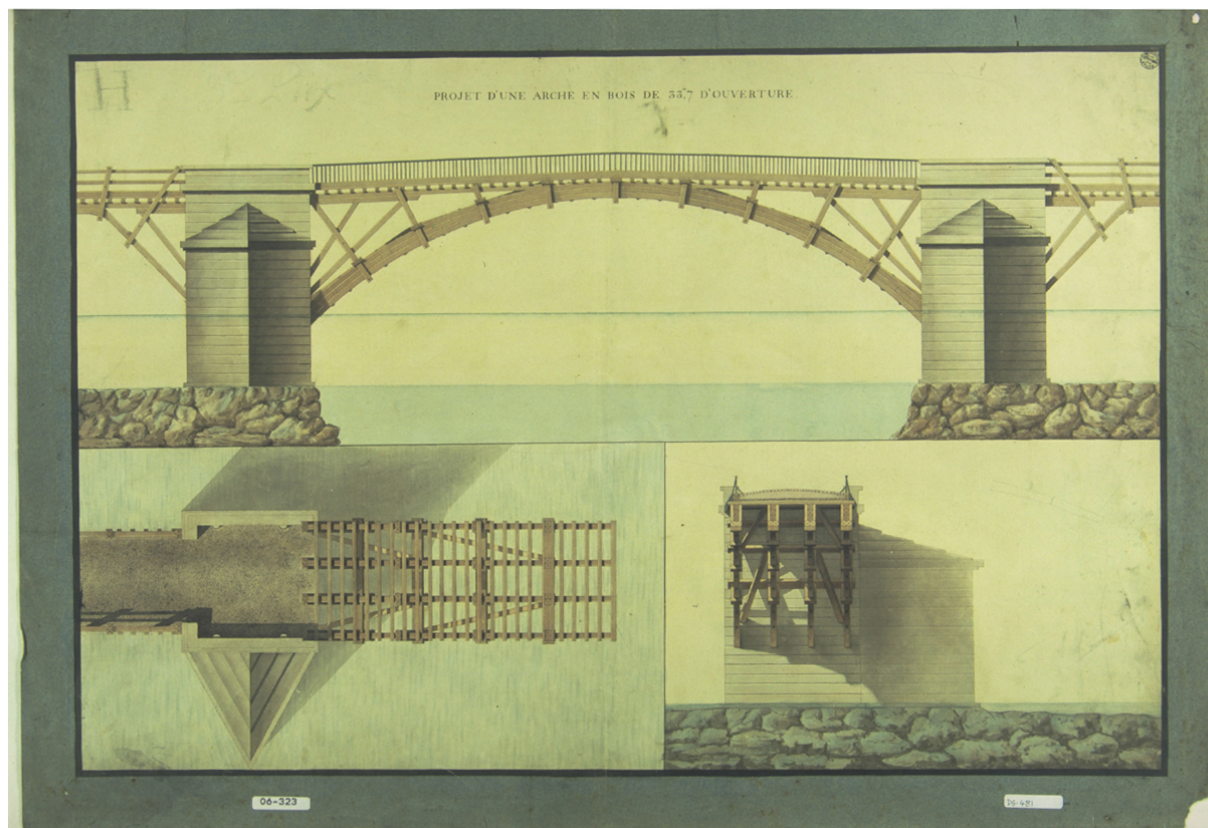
Progetto di un arco in legno di 33.7 m luce. Prospetto, pianta e sezione.
